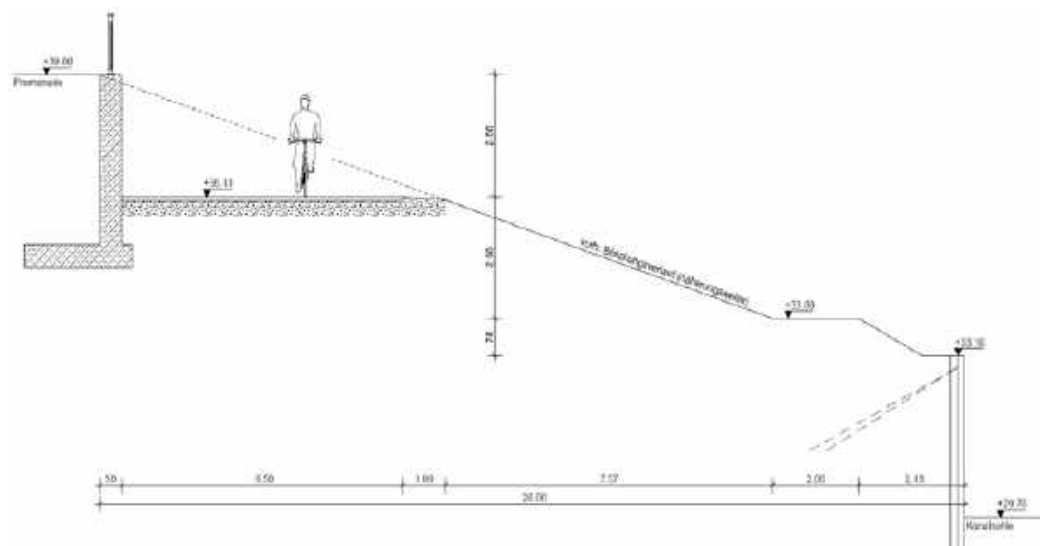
Stützbauwerk und Böschungsverlauf auf der südwestlichen Seite des Brückenbauwerks auf halber Rampenlänge
